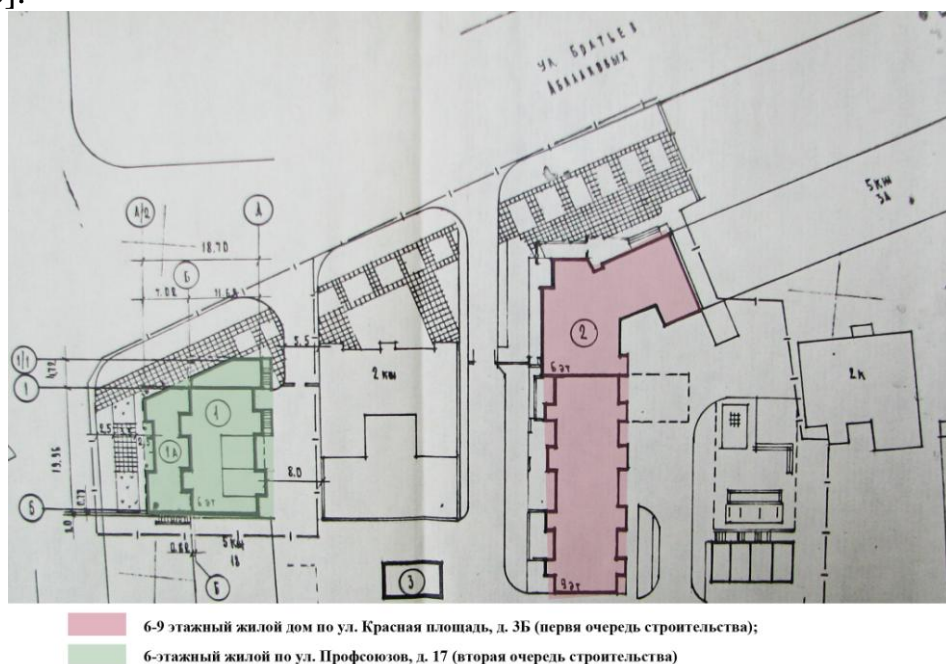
Чертеж генплана размещения двух жилых домов по ул. Красная площадь, д. 3Б и ул. Профсоюзов, д. 18
